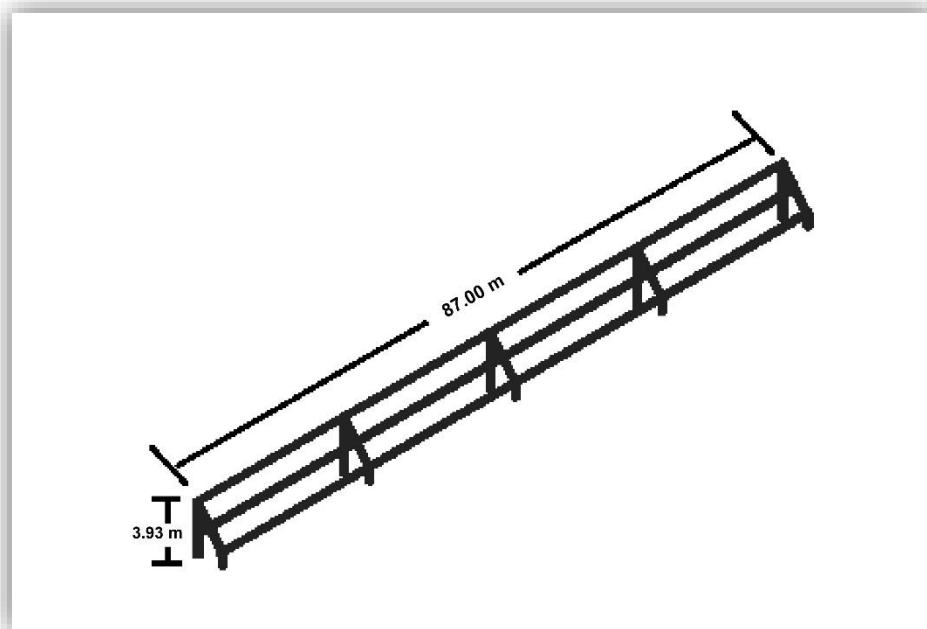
Vista general de un módulo o panel fotovoltaico tipo.
